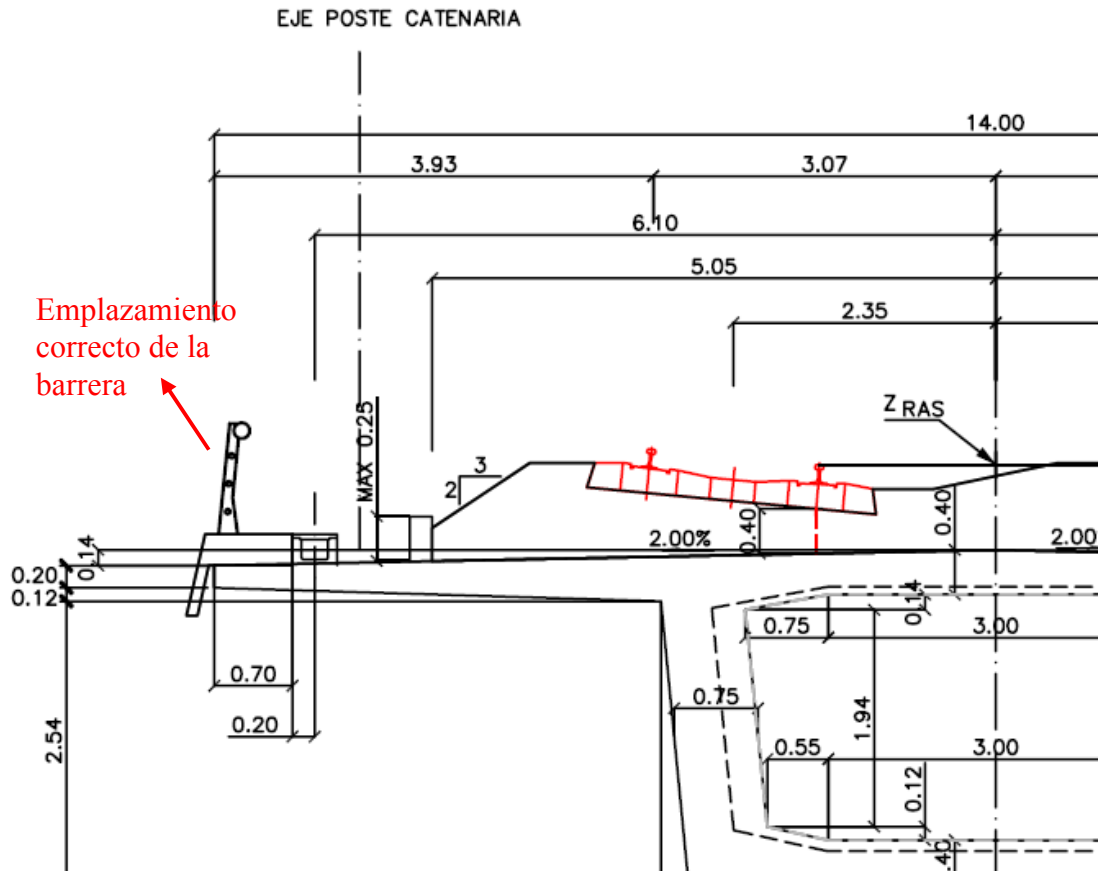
Posible emplazamiento de la barrera para-viento en estructura de vía sobre viaducto.
